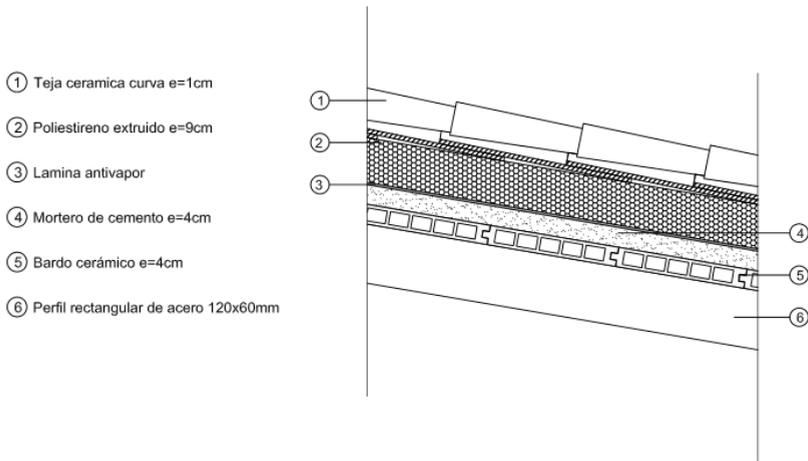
Detalle propuesta cubierta. 2014. Propia.
